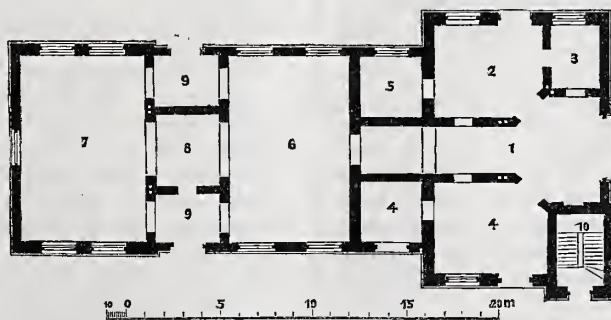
Grundriss vom Erdgeschoss.
